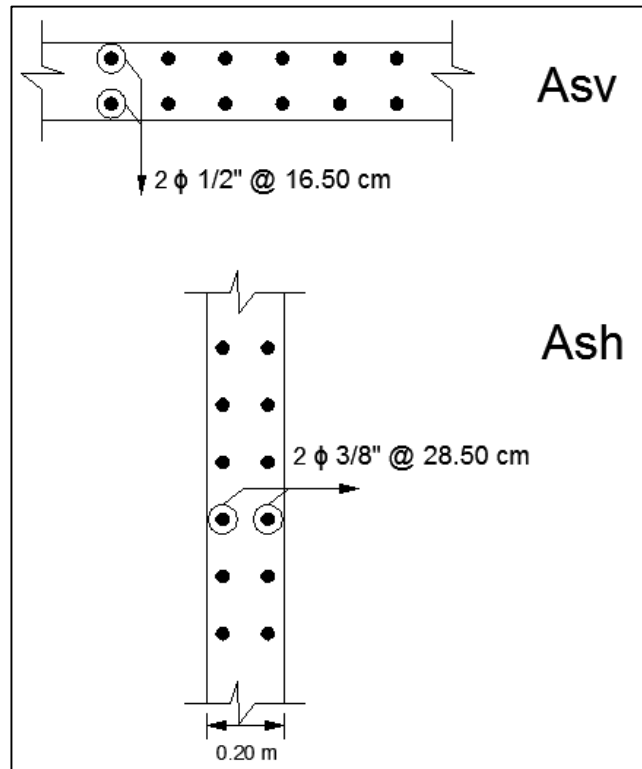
Refuerzo vertical y horizontal de la placa.
